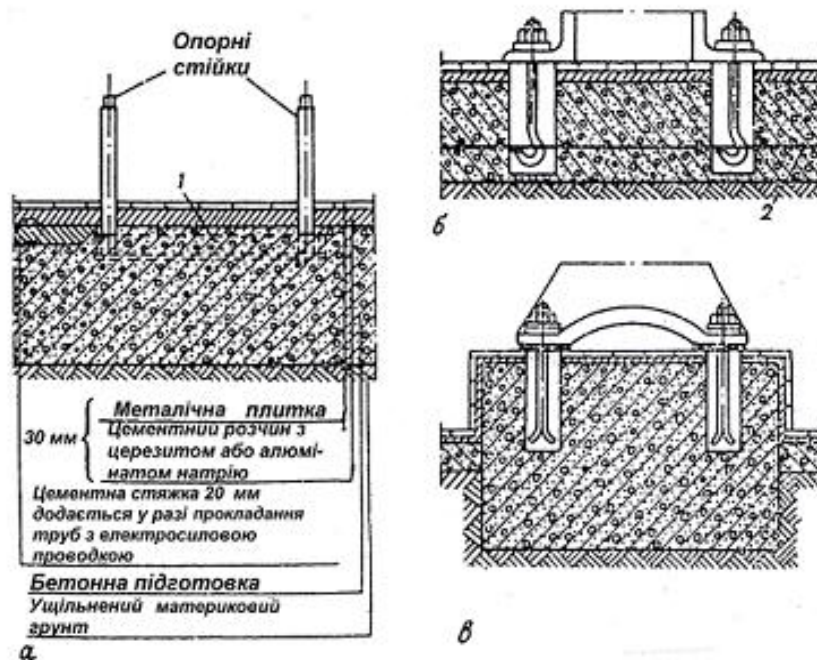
Способи кріплення обладнання на підлозі і фундаменті.
